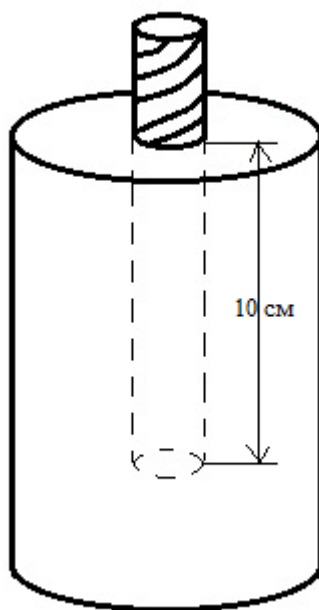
Схема образца для исследования состояния стальной арматуры в бетоне
